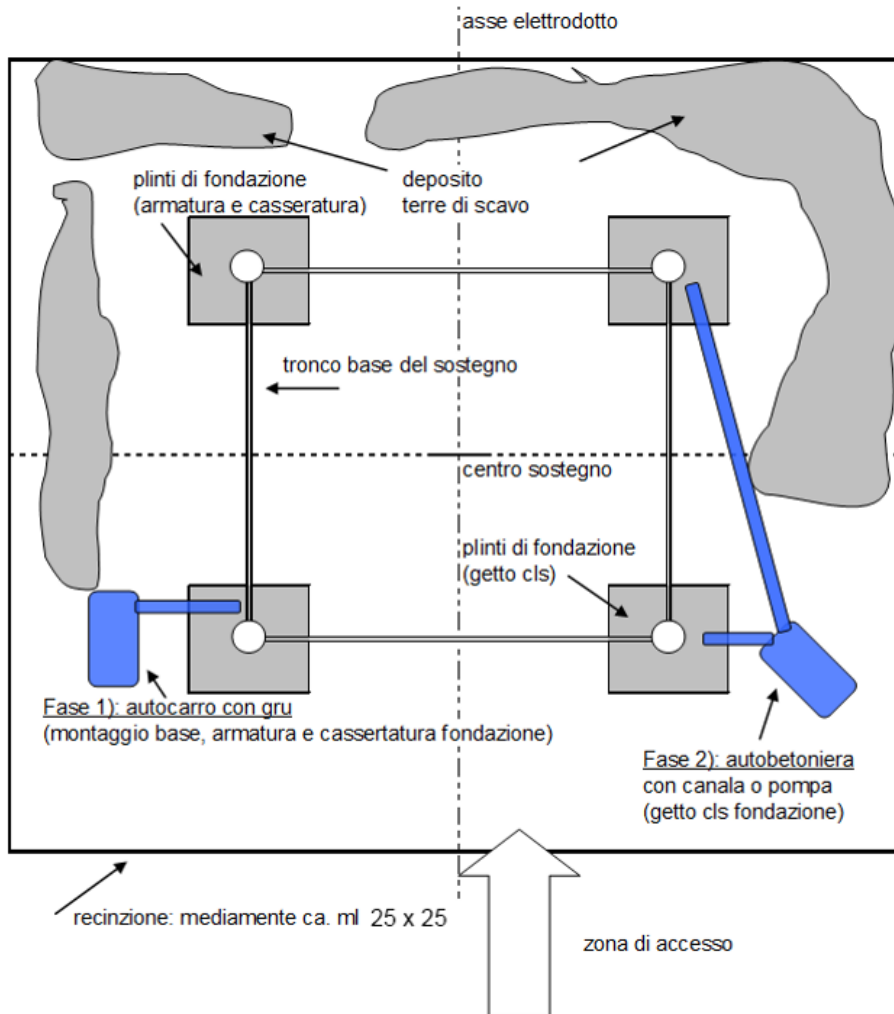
Layout tipo dell'area sostegno (getto e montaggio basi)
